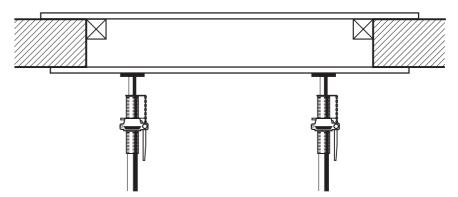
Copertura delle aperture praticate sul pavimento, suolo o nel solaio
